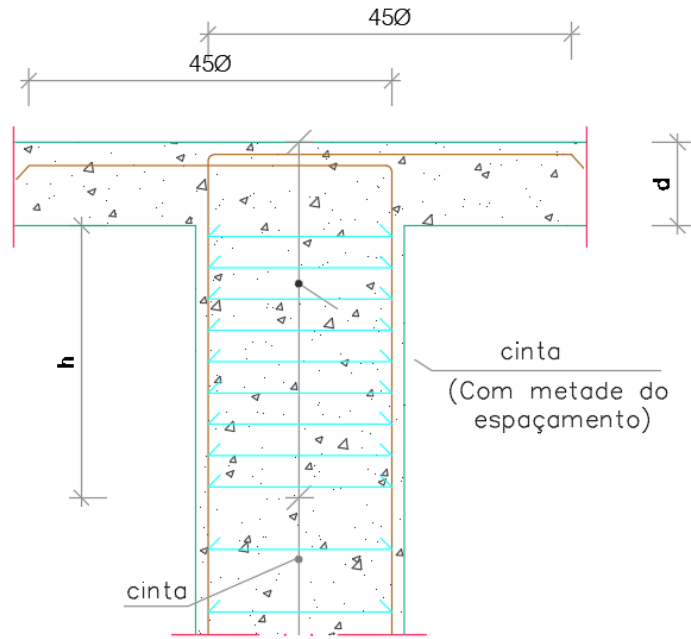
Amarração de armaduras em lajes e vigas (Projeto de estruturas).
